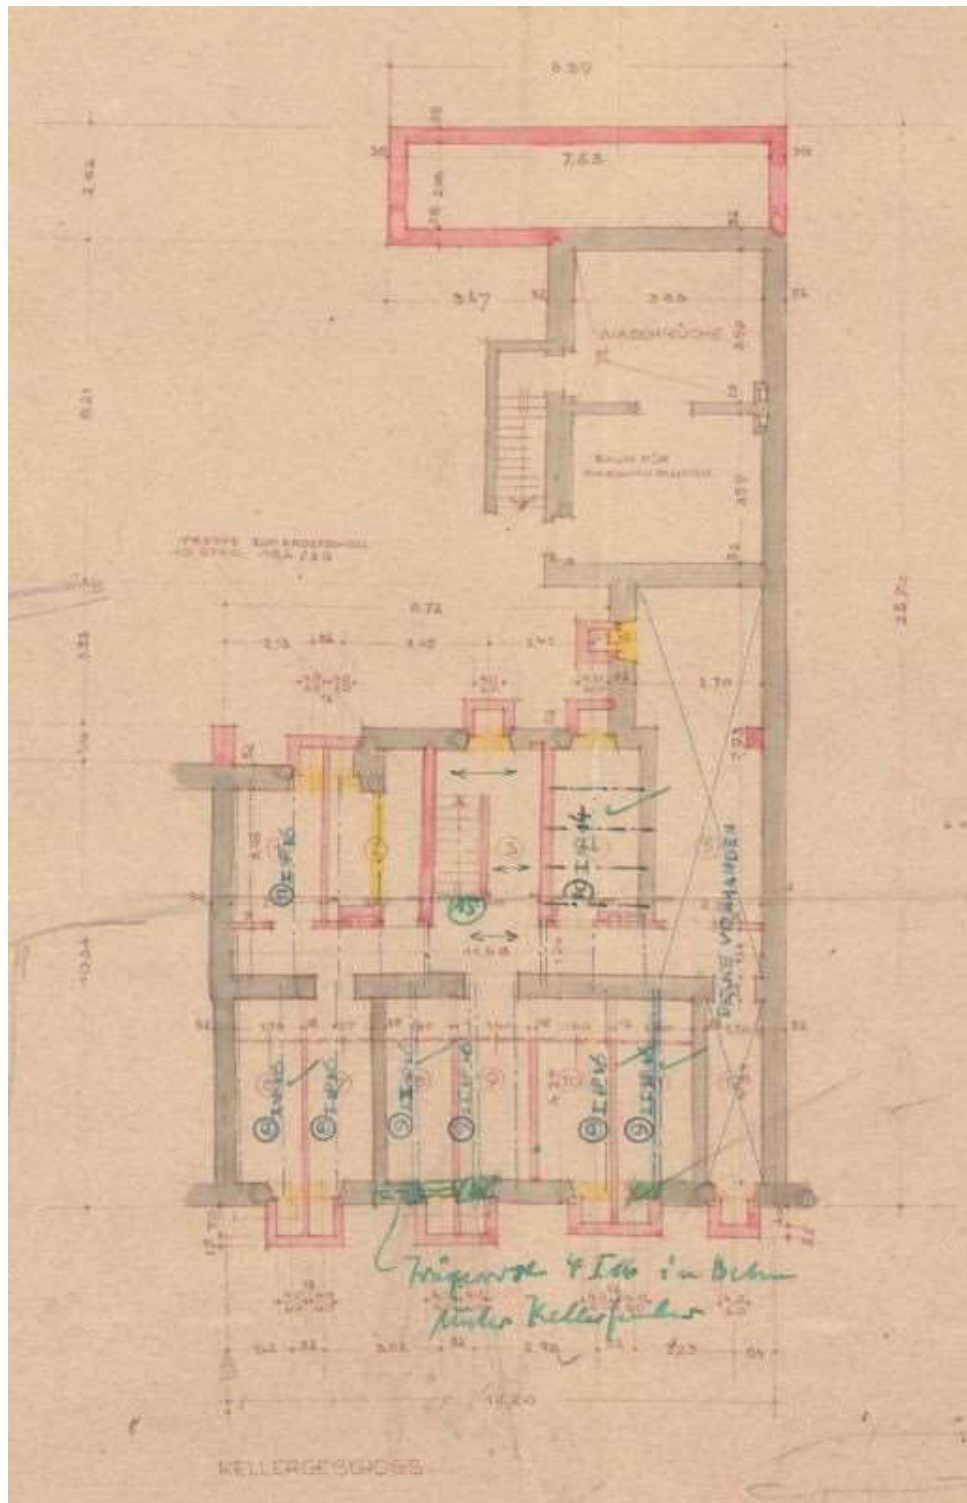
Grundriss Kellergeschoß (KG)
